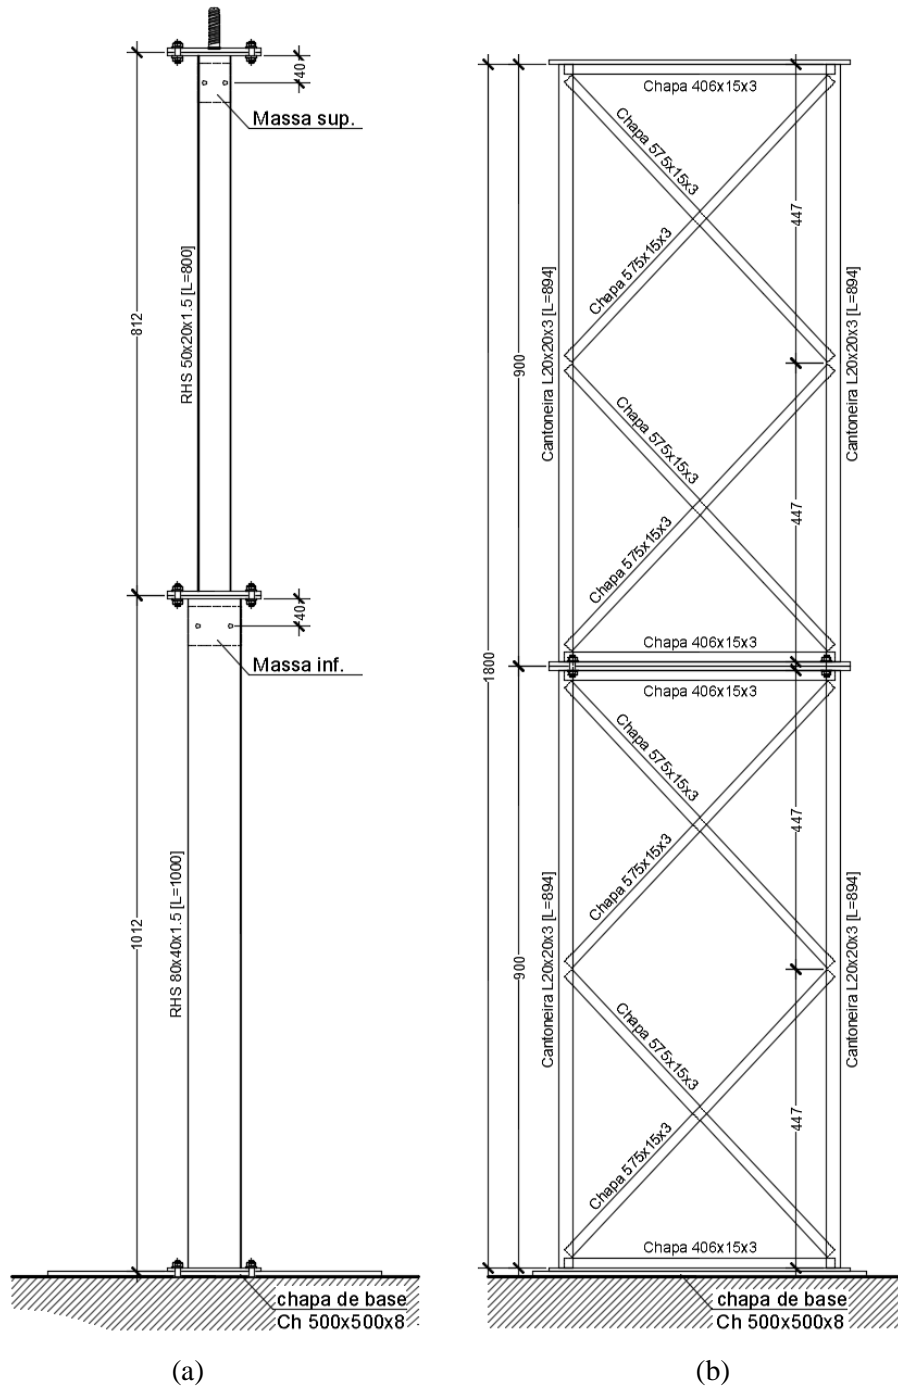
Dimensões gerais do demonstrador: a) alçado da estrutura interior; b) alçado da estrutura de reação; (cotas em milímetros).
